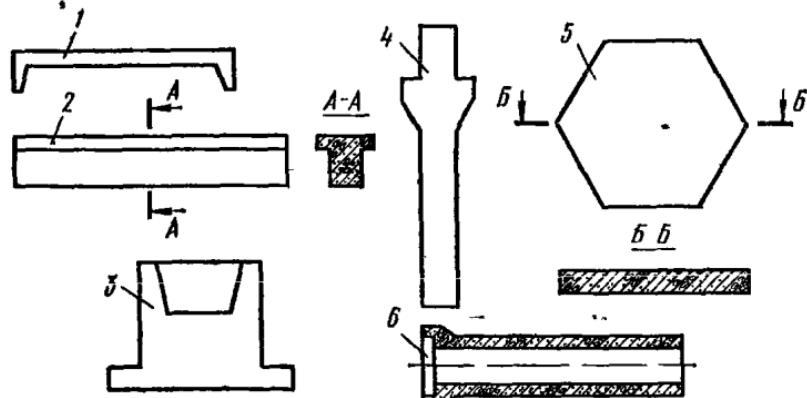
Сборные бетонные и железобетонные изделия и детали:
